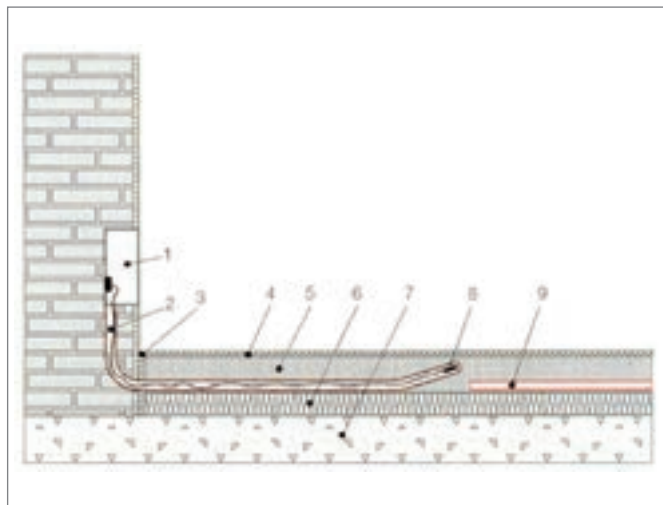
Installazione della sonda di temperatura pavimento FT-HC
